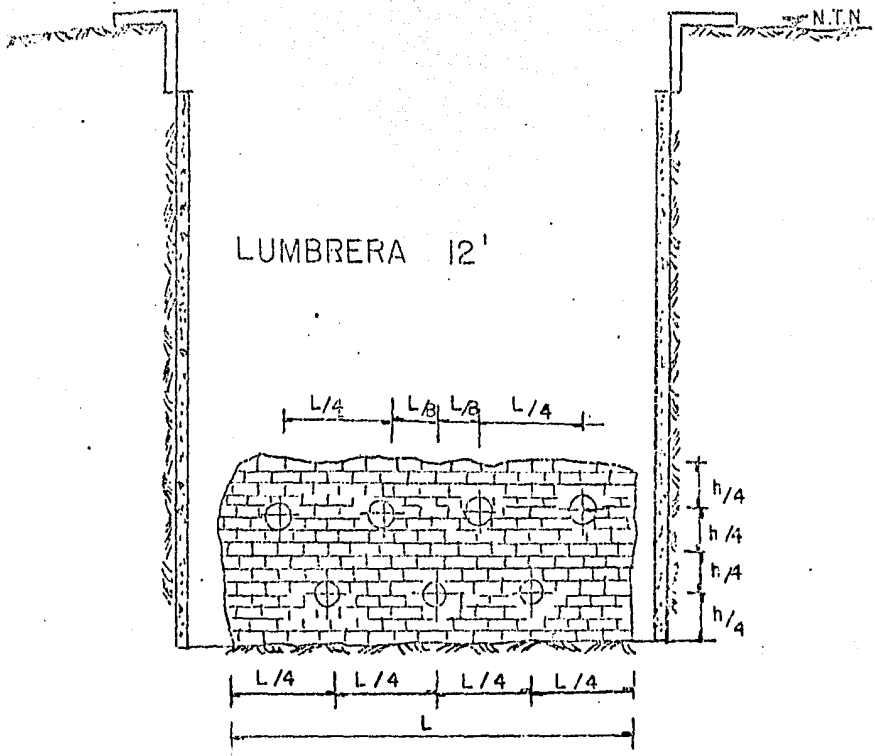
PLANTA LOCALIZACION DE CAVERNAS
